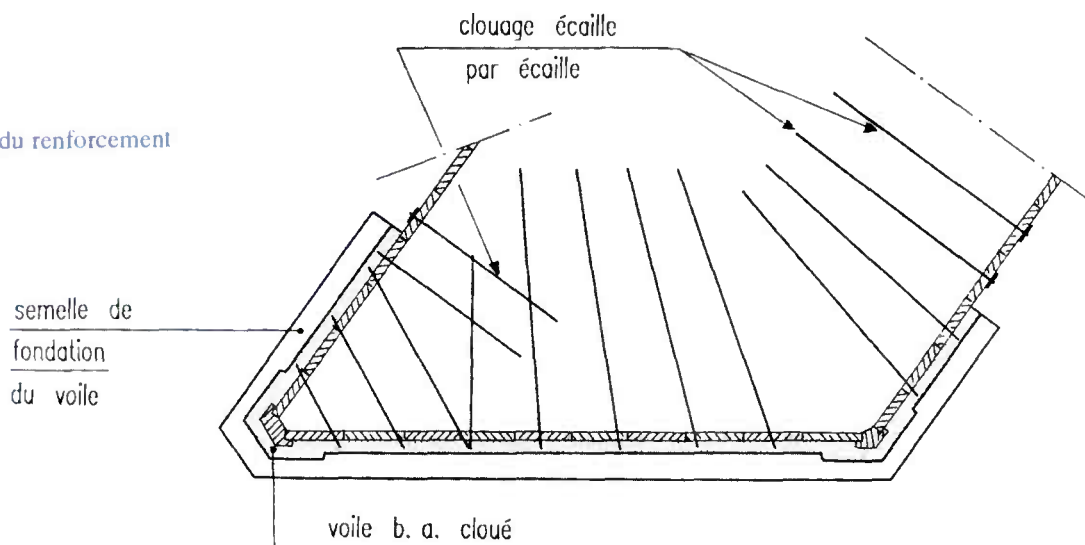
Renforcement d'une culée en terre armée par clouage avec voile
